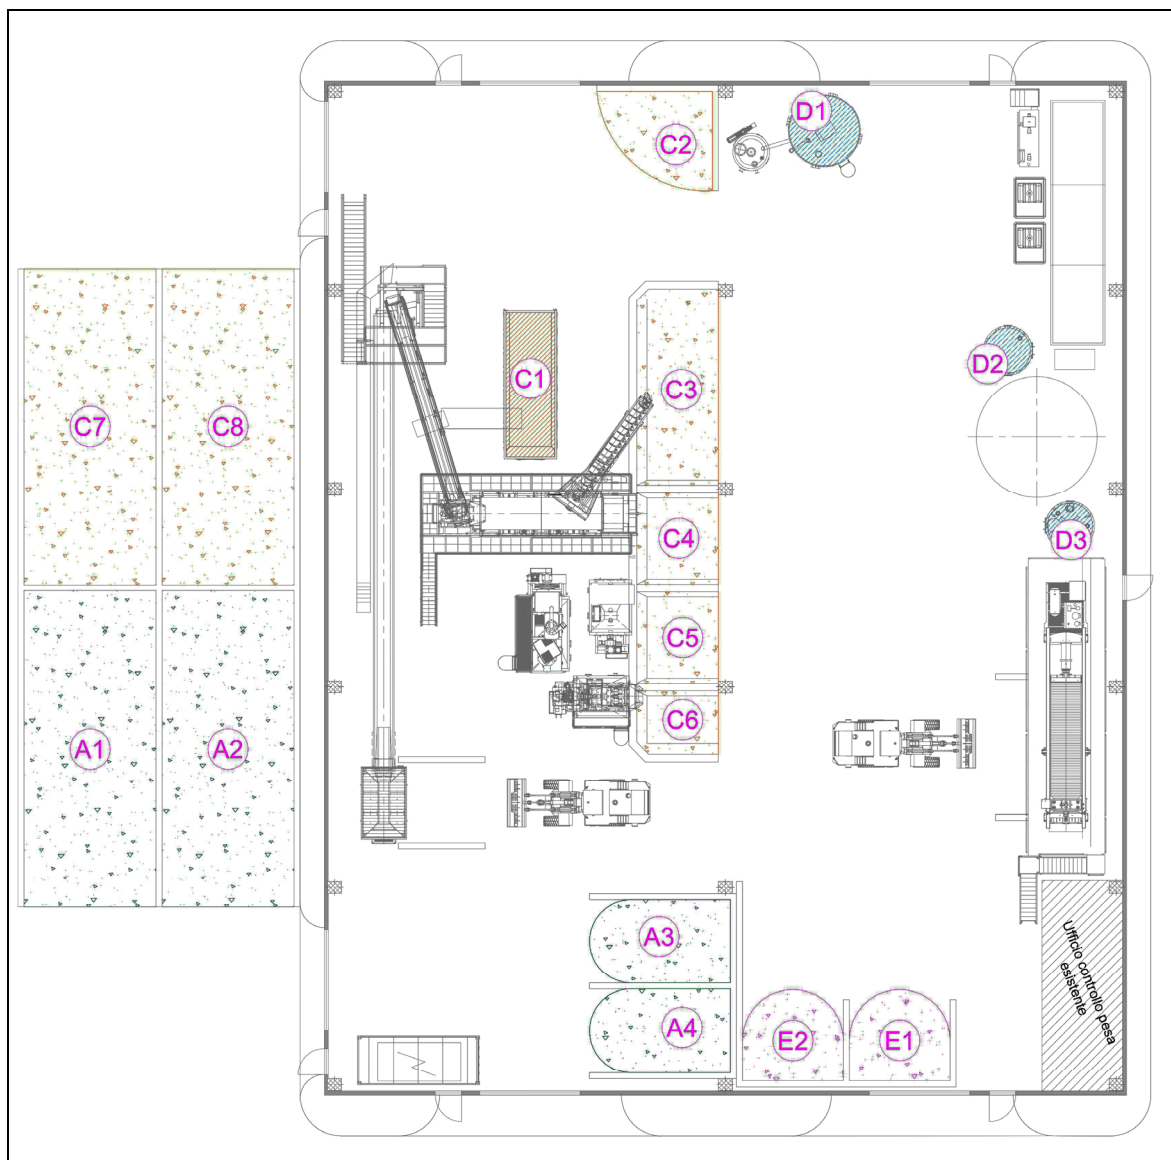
Planimetria con indicazione degli stoccaggi previsti in impianto
